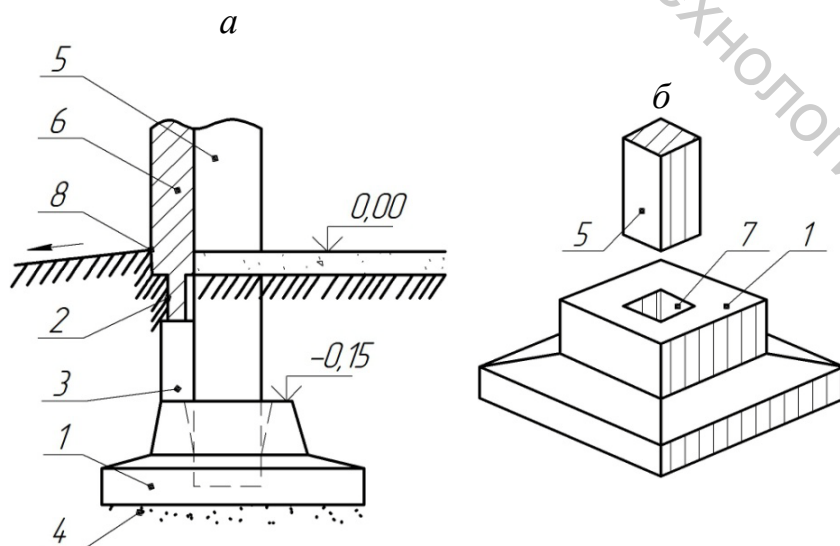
Сборный железобетонный фундамент стаканного типа: а – схема; б – общий вид;
